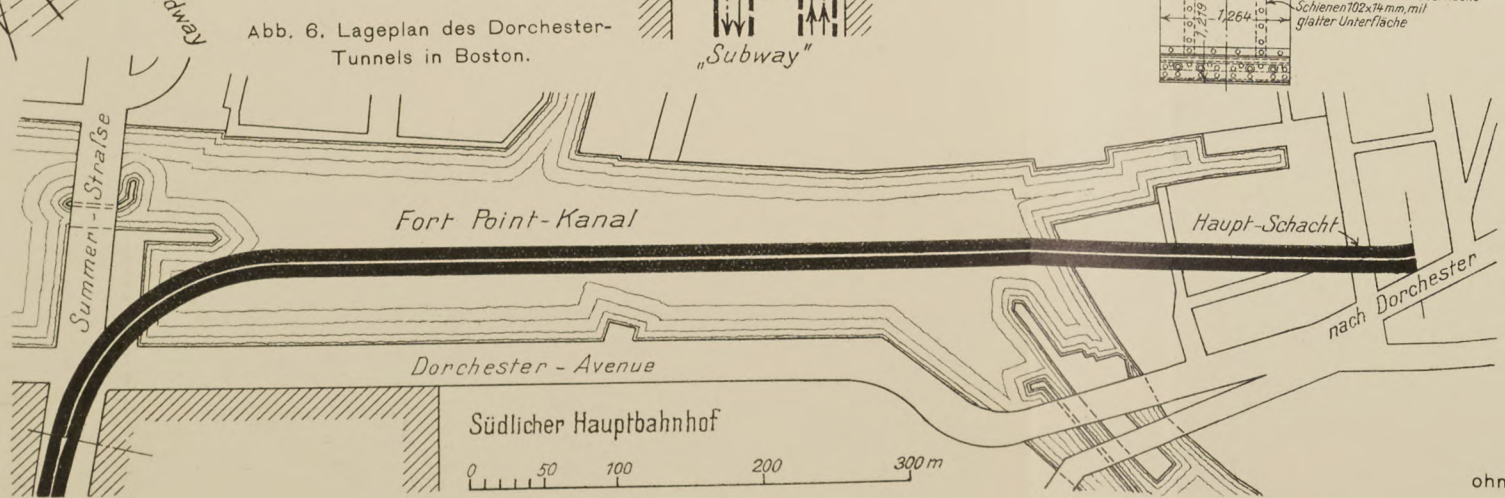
Lageplan des Dorchester-Tunnels in Boston.
